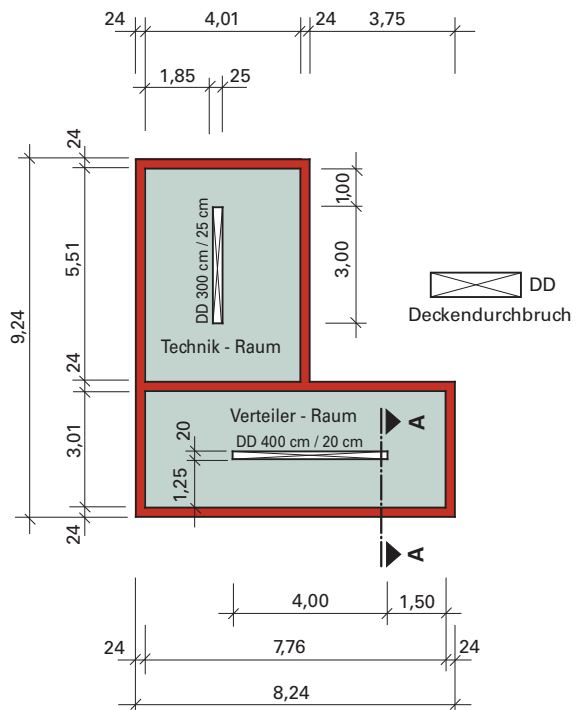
Schalplan für eine Stahlbetondecke über dem Technik- und Verteilerraum
